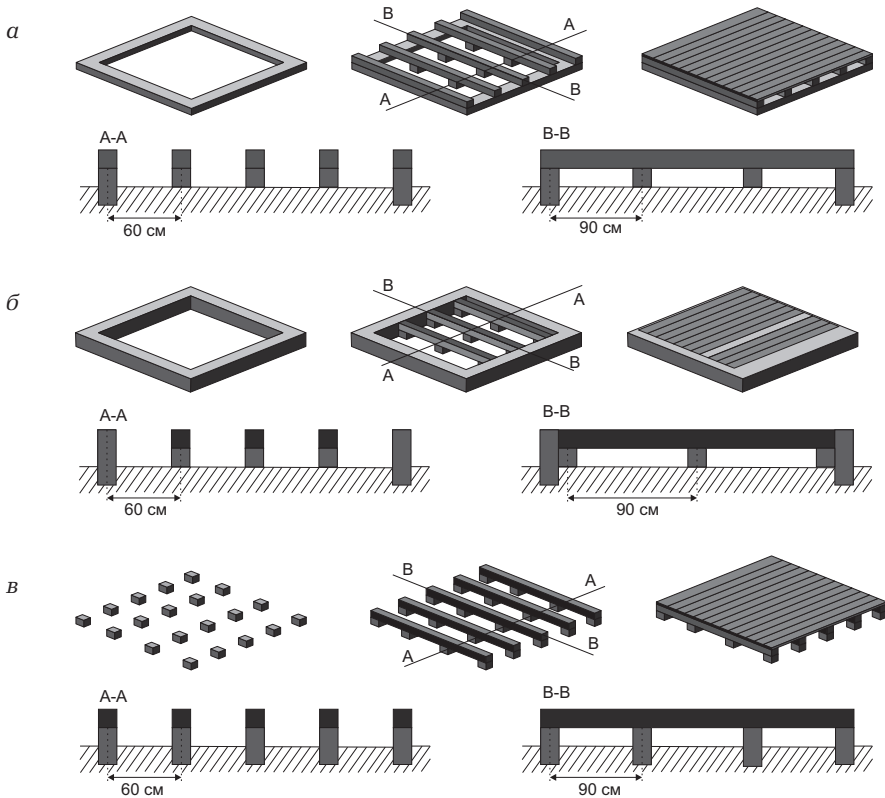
Настил полов с установкой балок: а — на прямоугольный фундамент; б — на уровне фундамента; в — на столбчатый фундамент
